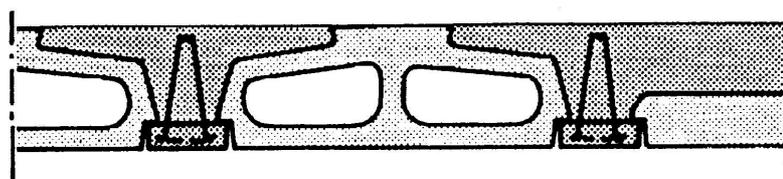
Stahlbetonbalkendecke, statisch nicht mitwirkende Zwischenbauteile
